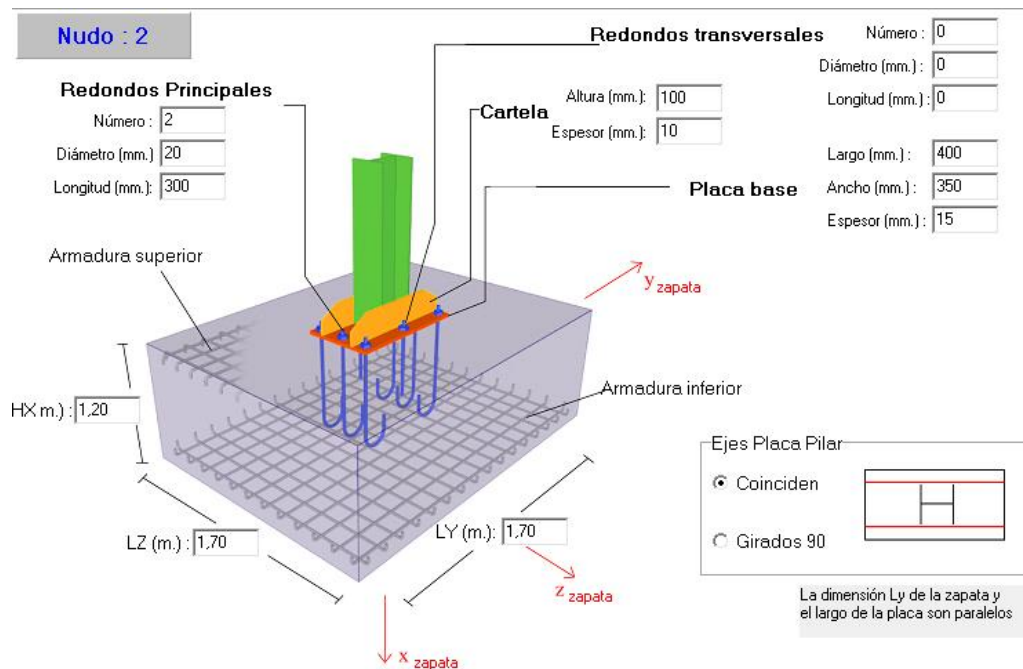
Zapata 2 y 4 pórtico inicial/final.
